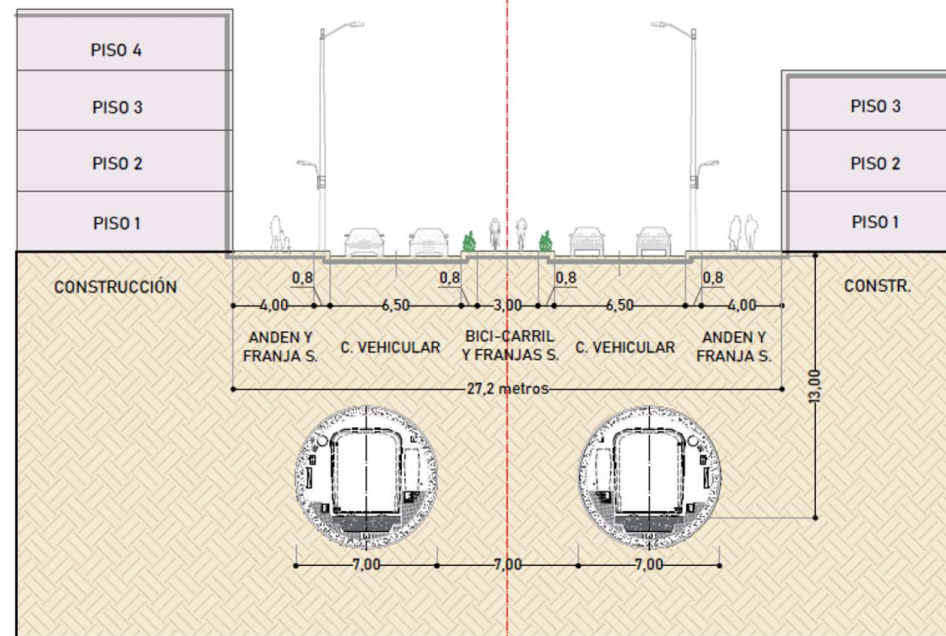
Perfil V2 sistema metro- Fuente: Egis - Steer( 2021)
